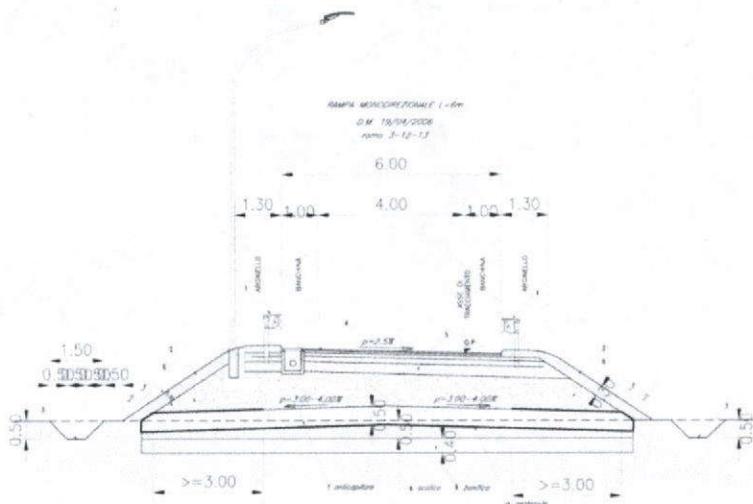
Sezione tipo rampa monodirezionale in rilevato alto
